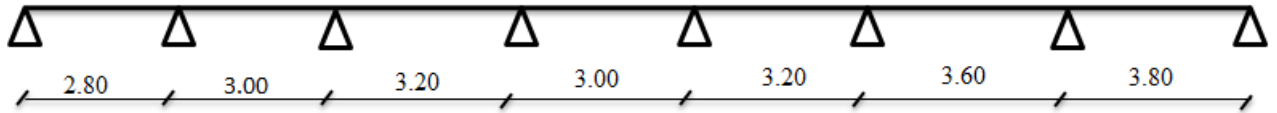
Poutrelle type 01 (Plancher Sous-Sol -usage commerciale-)
